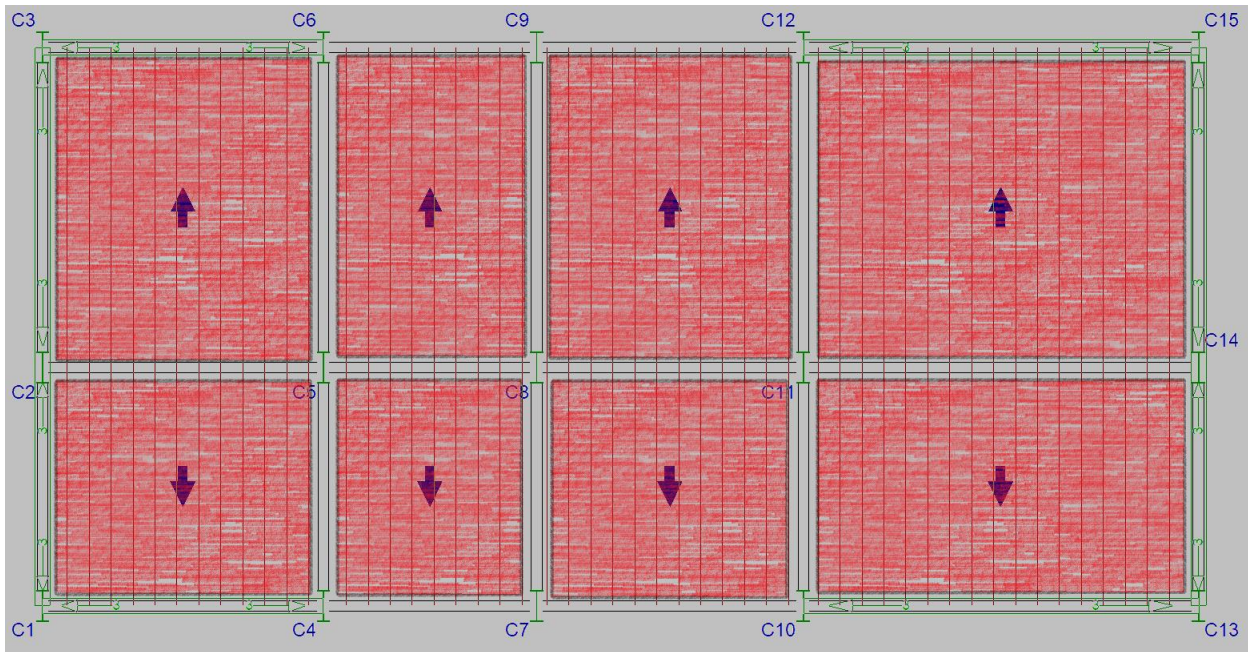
Losa aligerada con viguetas metálicas nivel 2
